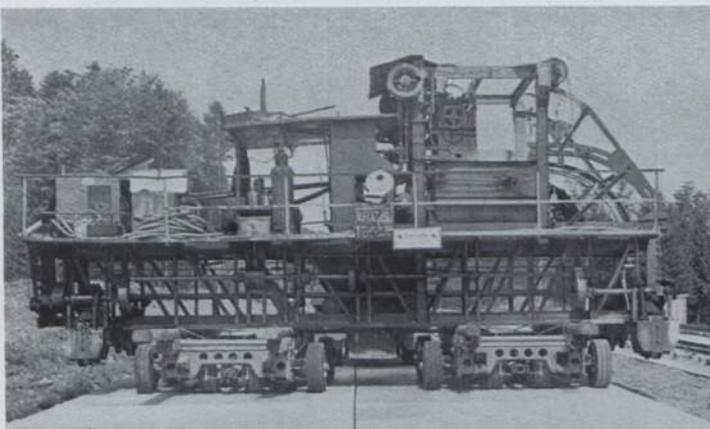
Beförderung einer 9 m breiten Straßenbetoniermaschine auf zwei Fahrgestellen nebeneinander. (Foto Reichsbahn.)
